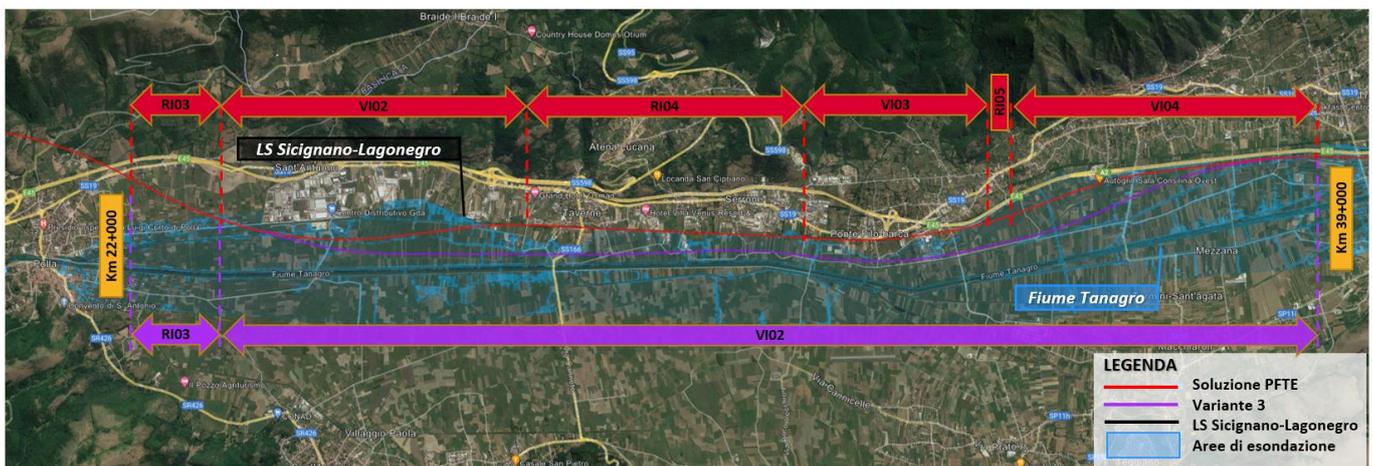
Stralcio planimetrico con confronto soluzione PFTE e variante 3
